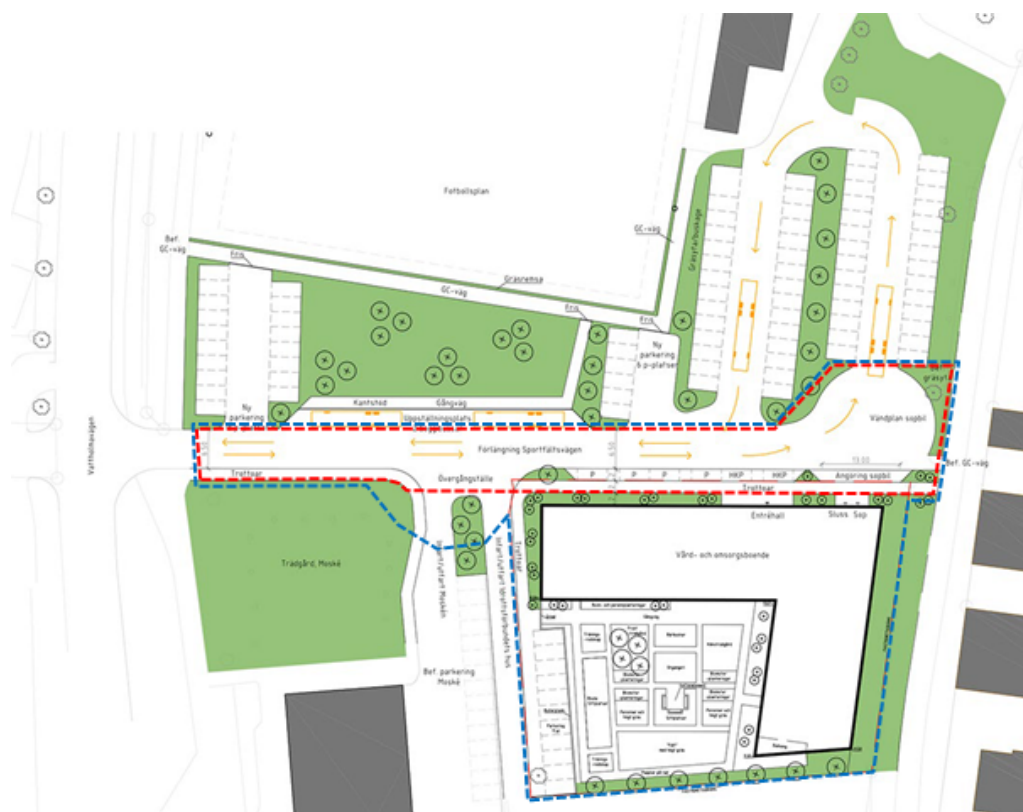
Illustrationsplan för trafiklösning vid planområdet. Planområdet markeras med blå streckad linje. Gatan markeras med röd streckad linje (bild: Karavan landskap)
